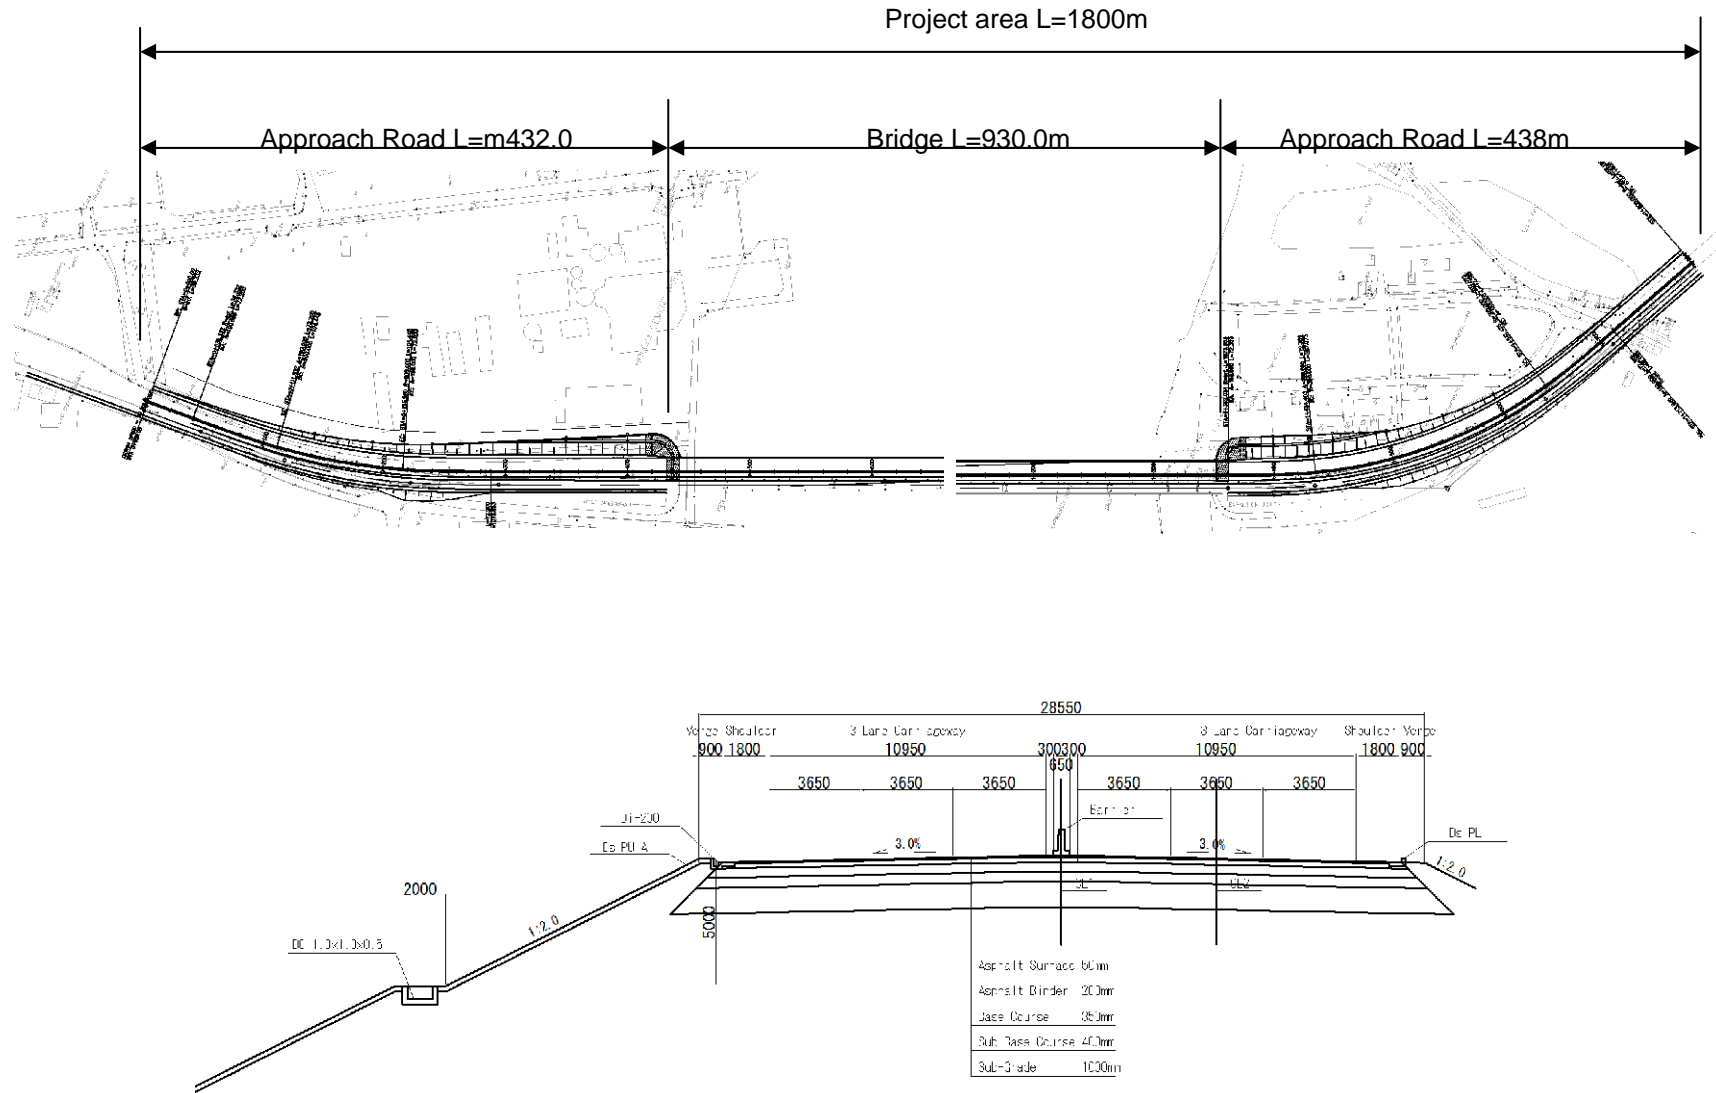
平面図、標準横断図 (第2メグナ橋)
